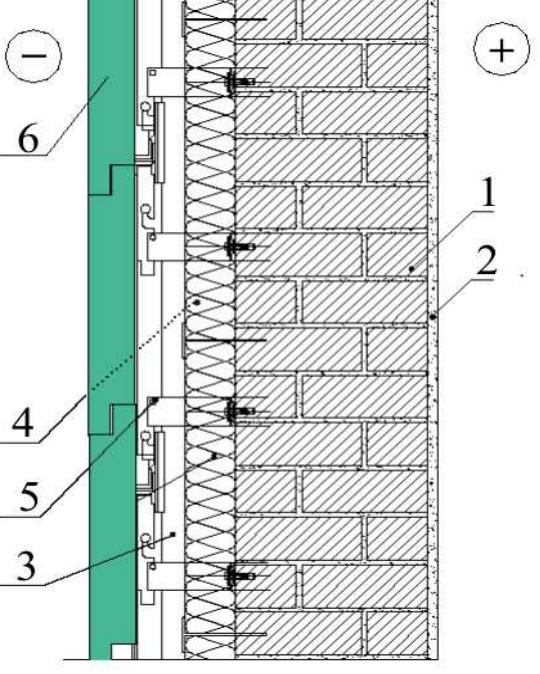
Схема устрою теплоізоляції за способом вентильованого фасаду: 1 – зовнішня стіна; 2 – утеплювач; 3 – анкер; 4 – напрямні; 5 – вітробар’єр; 6 – зовнішній захисно-декоративний шар
